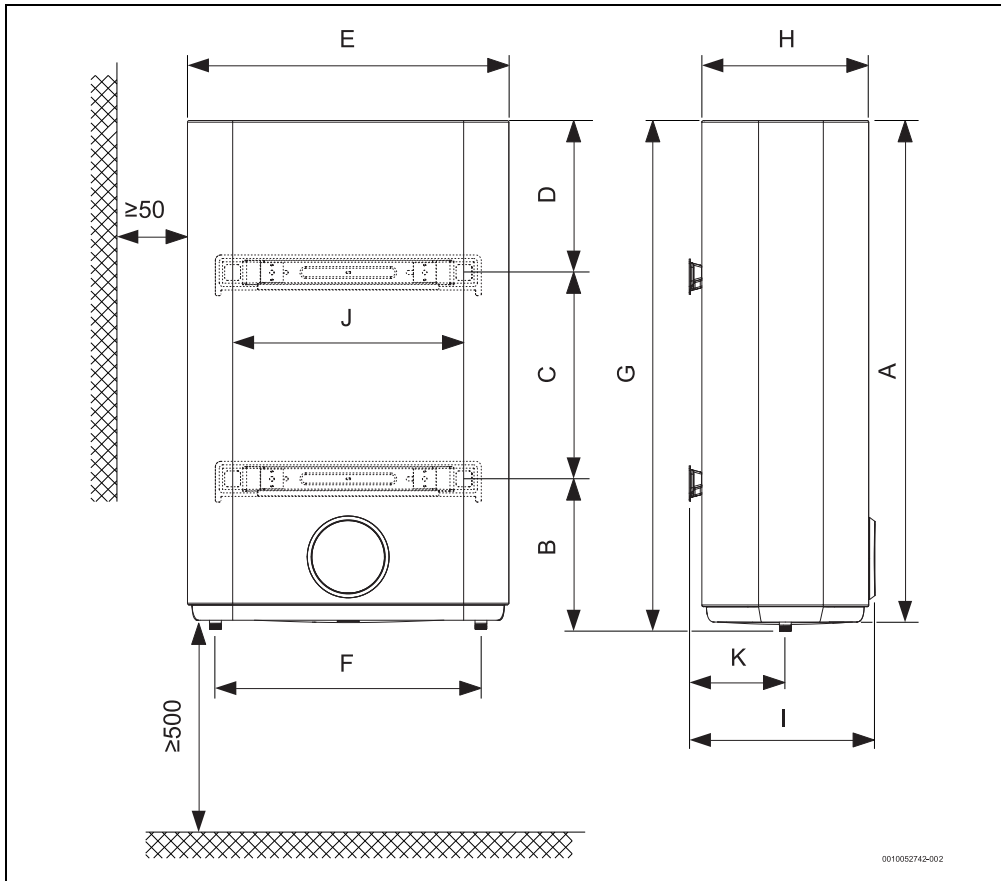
Dimensões em mm (montagem mural, instalação vertical)
